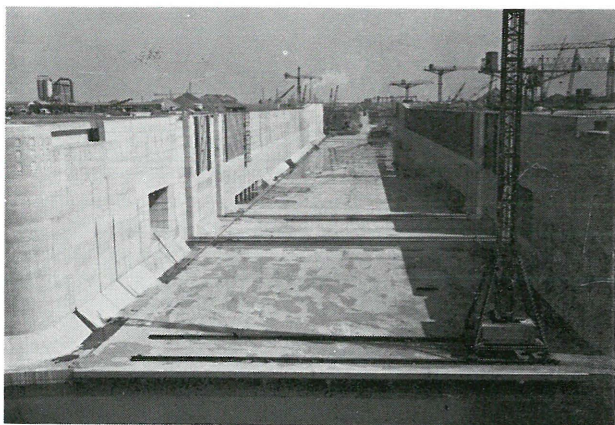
Algemeen zicht op voltooid betonwerk van de sluis.
